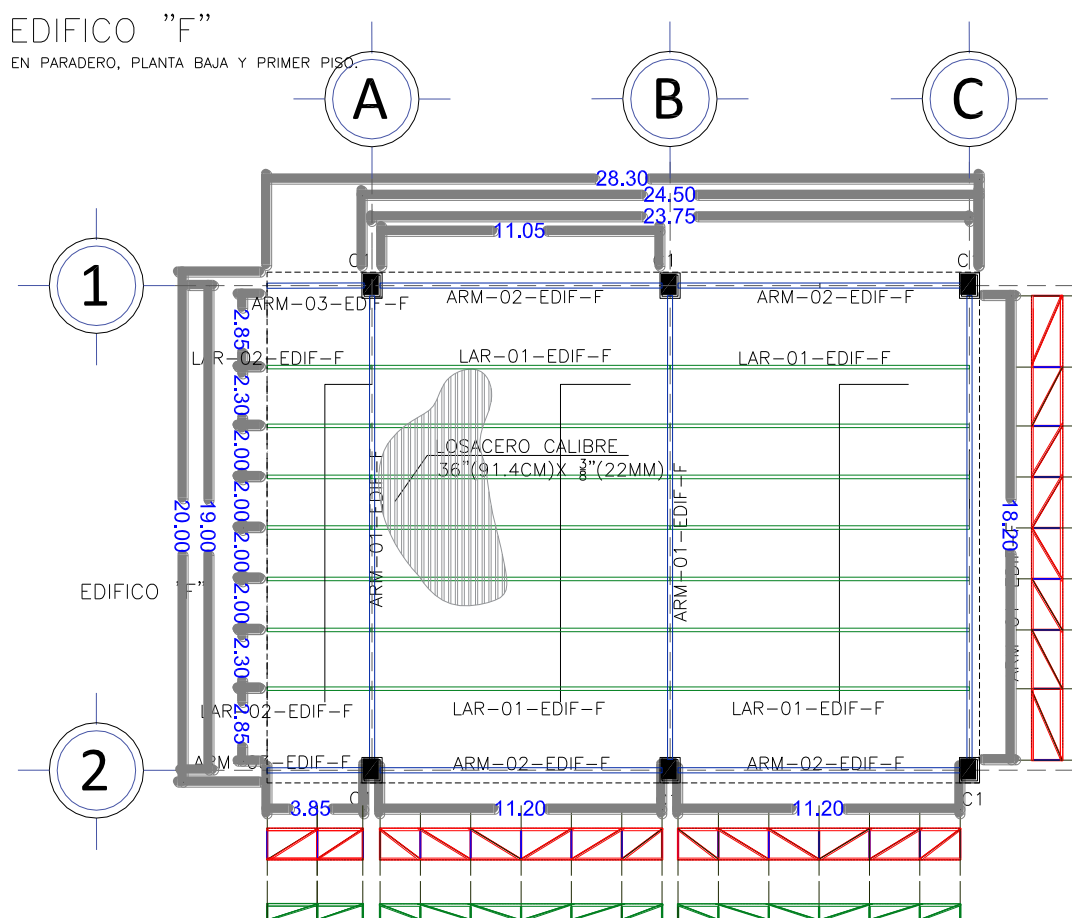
, Elaboración Propio (2017), planta estructural, conjunto "A", edificio "F".
